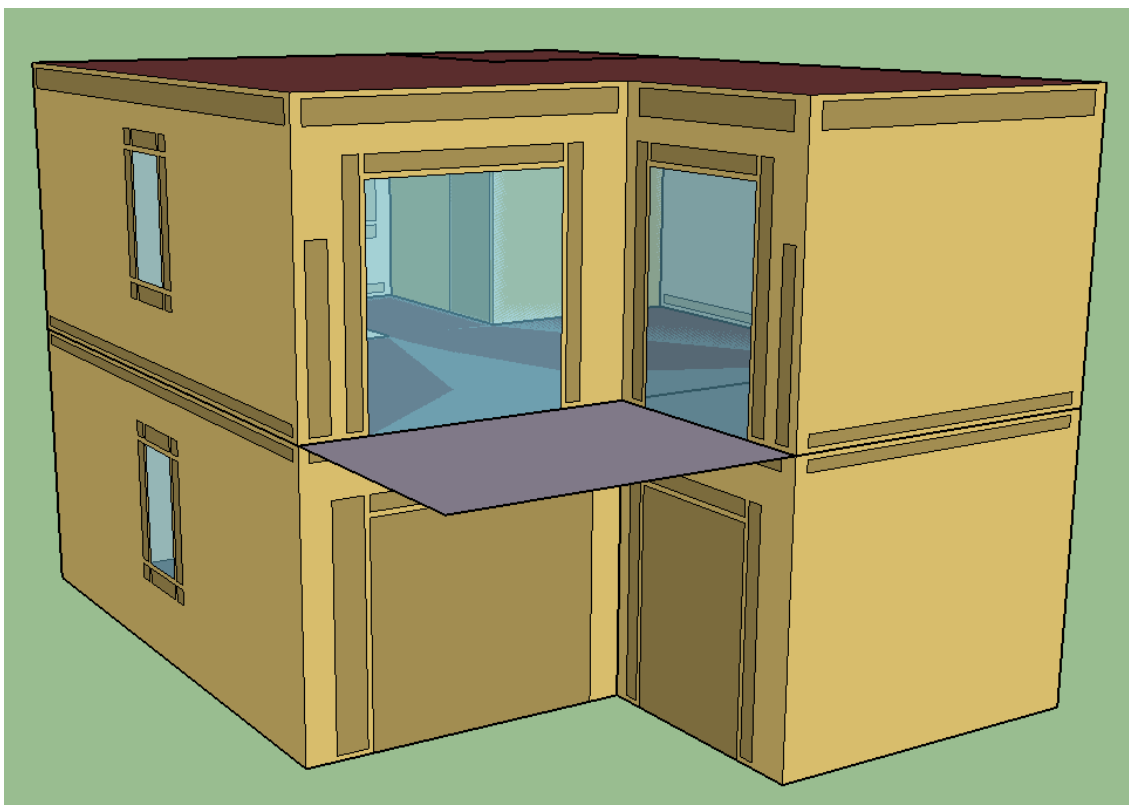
Vista exterior 1 de la vivienda modelo SketchUp
